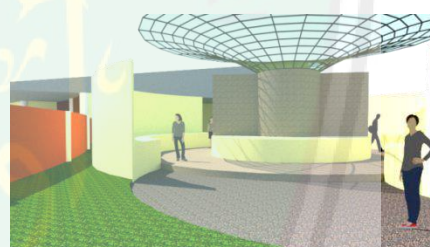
Tampilan Ruang Bangunan Lobi dan Kantor
